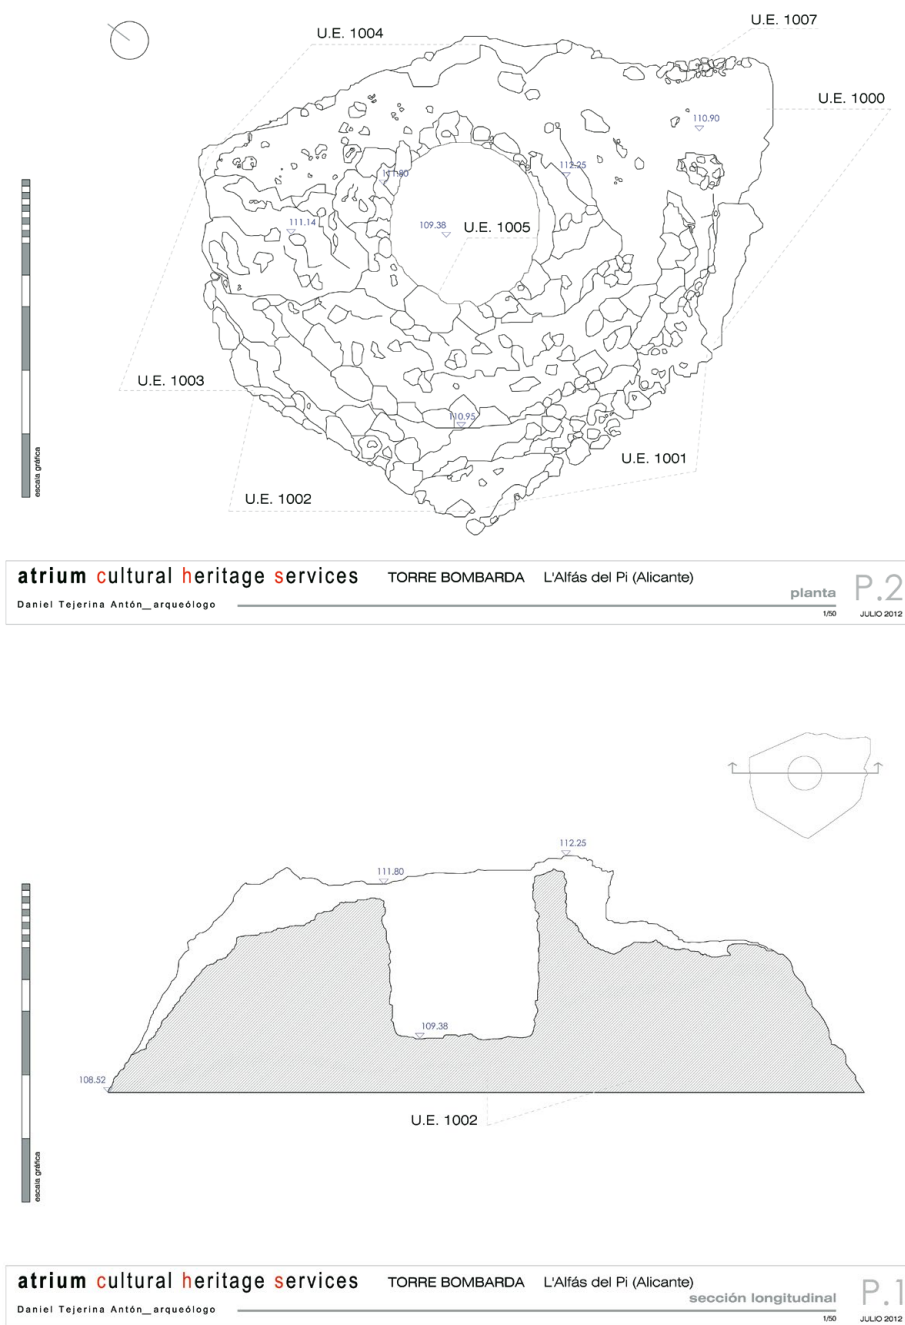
Planta y sección de la torre Bombarda (Daniel Tejerina).
